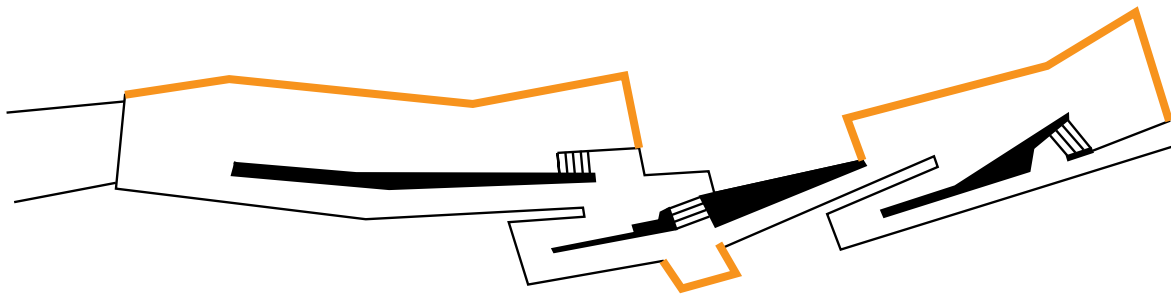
Zonas donde se encuentra actualmente el parapeto de madera
